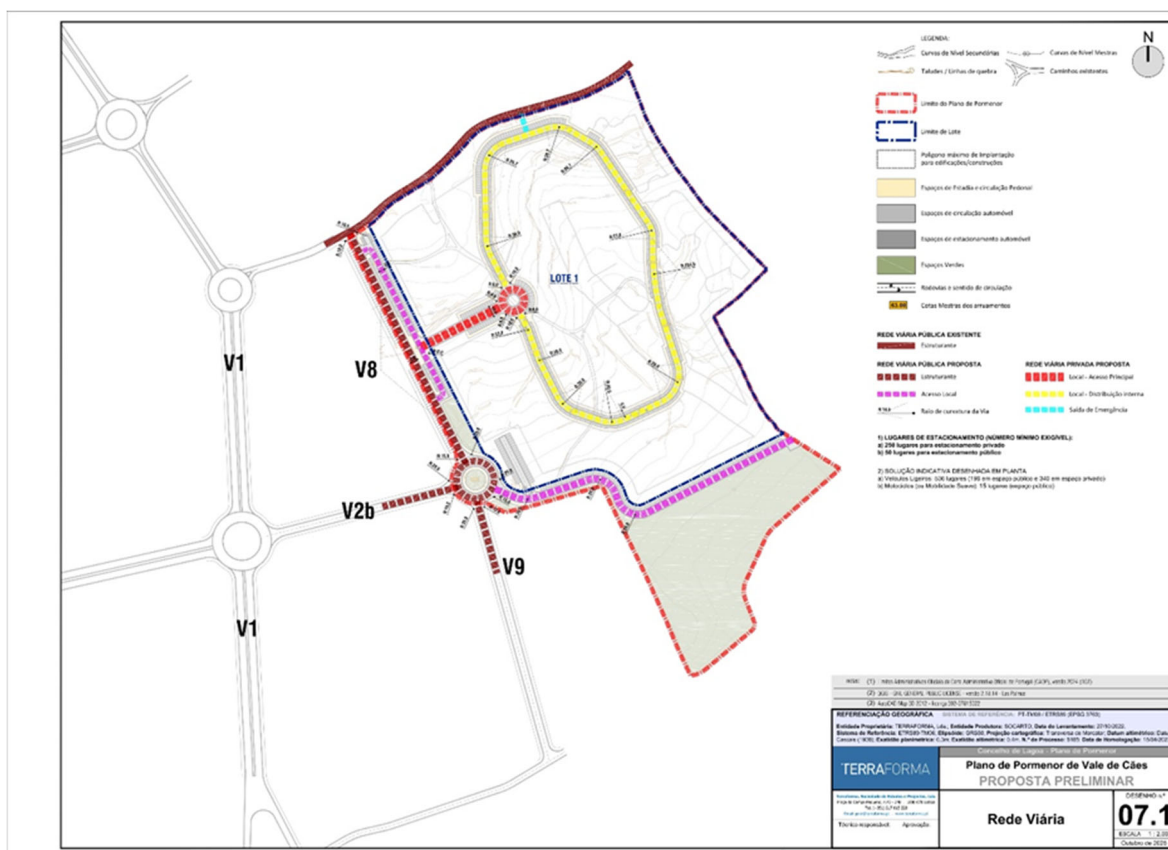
Planta da Rede Viária da Proposta do PPVC
